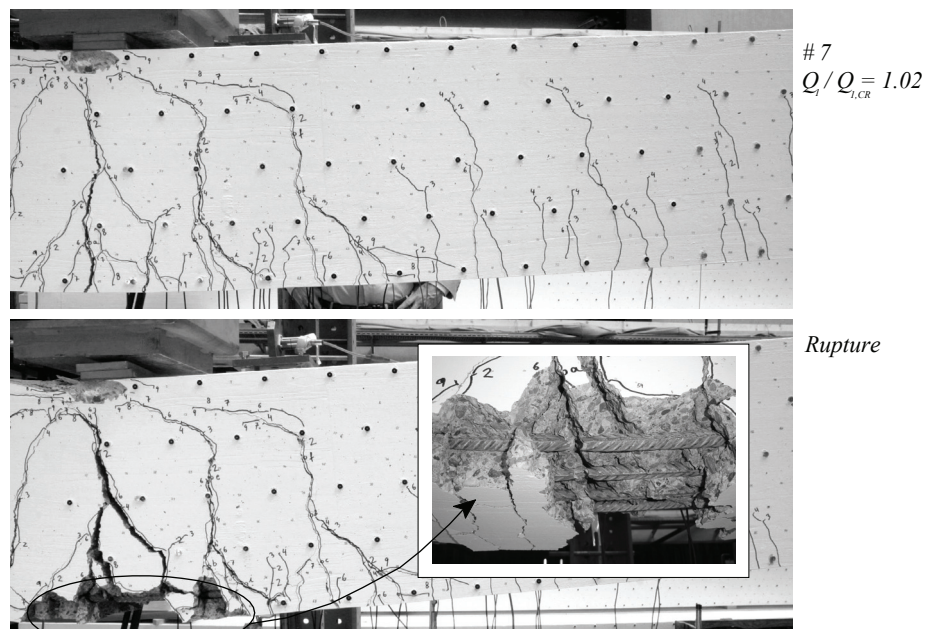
Poutre SR5: Fissuration avant rupture en travée (palier 9) et après rupture
